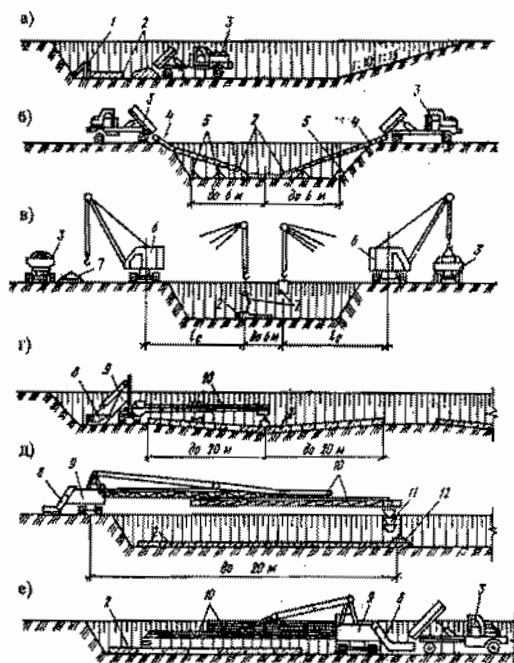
Схема устройства щебеночной и бетонной подготовки под днища емкостных сооружений: 1 - опалубка; 2 - щебень или бетонная смесь; 3 - автосамосвал; 4 - виброжелоб; 5 - опоры; 6 - кран; 7 - бады; 8 - скиповый подъемник; 9 - бетоноукладчик; 10 - конвейер; 11 - хобот; 12 - вибратор
